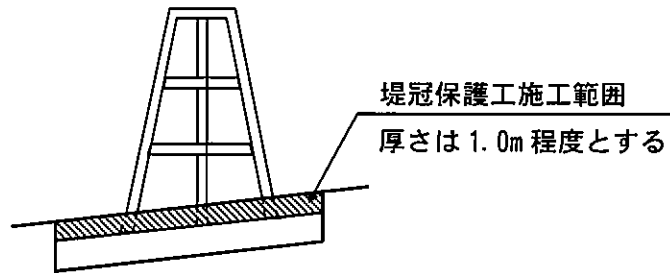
透過型堰堤の底版コンクリートの堤冠保護工施工範囲
